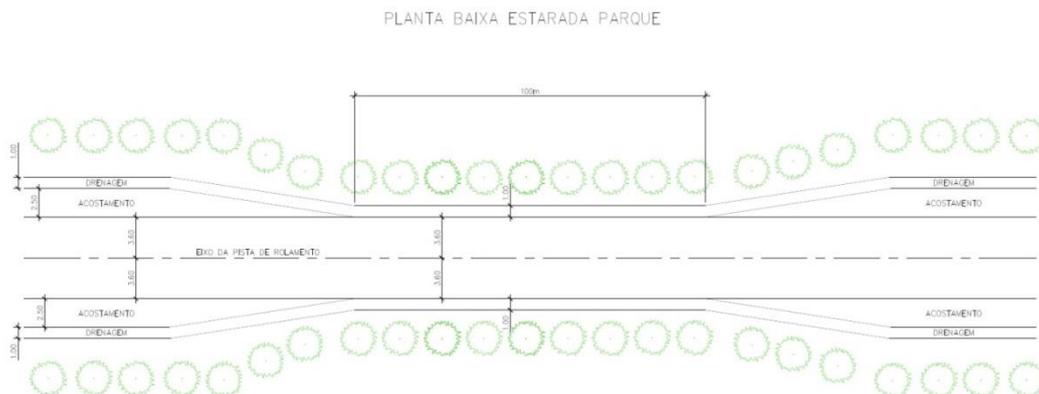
Planta de uma EP Modelo na Amazônia com pista de rolamento, acostamento e sistema de drenagem.
